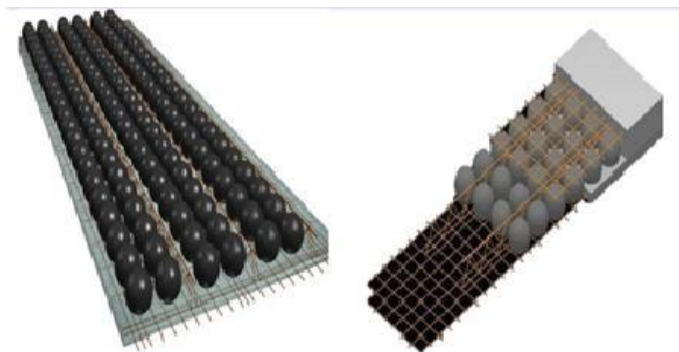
Esquema Losas Bubbledeck (filigree element) [6]
